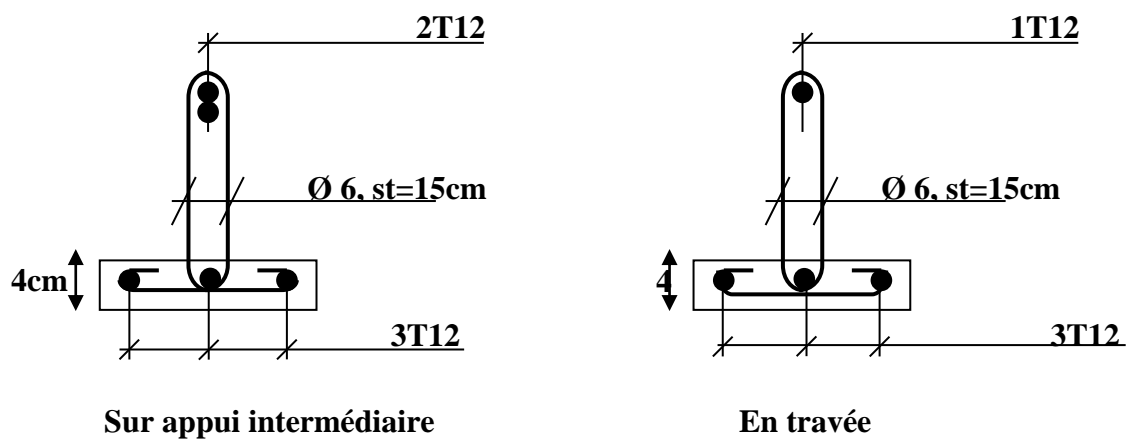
Schémas ferrailage des poutrelles plancher Terrasse.
